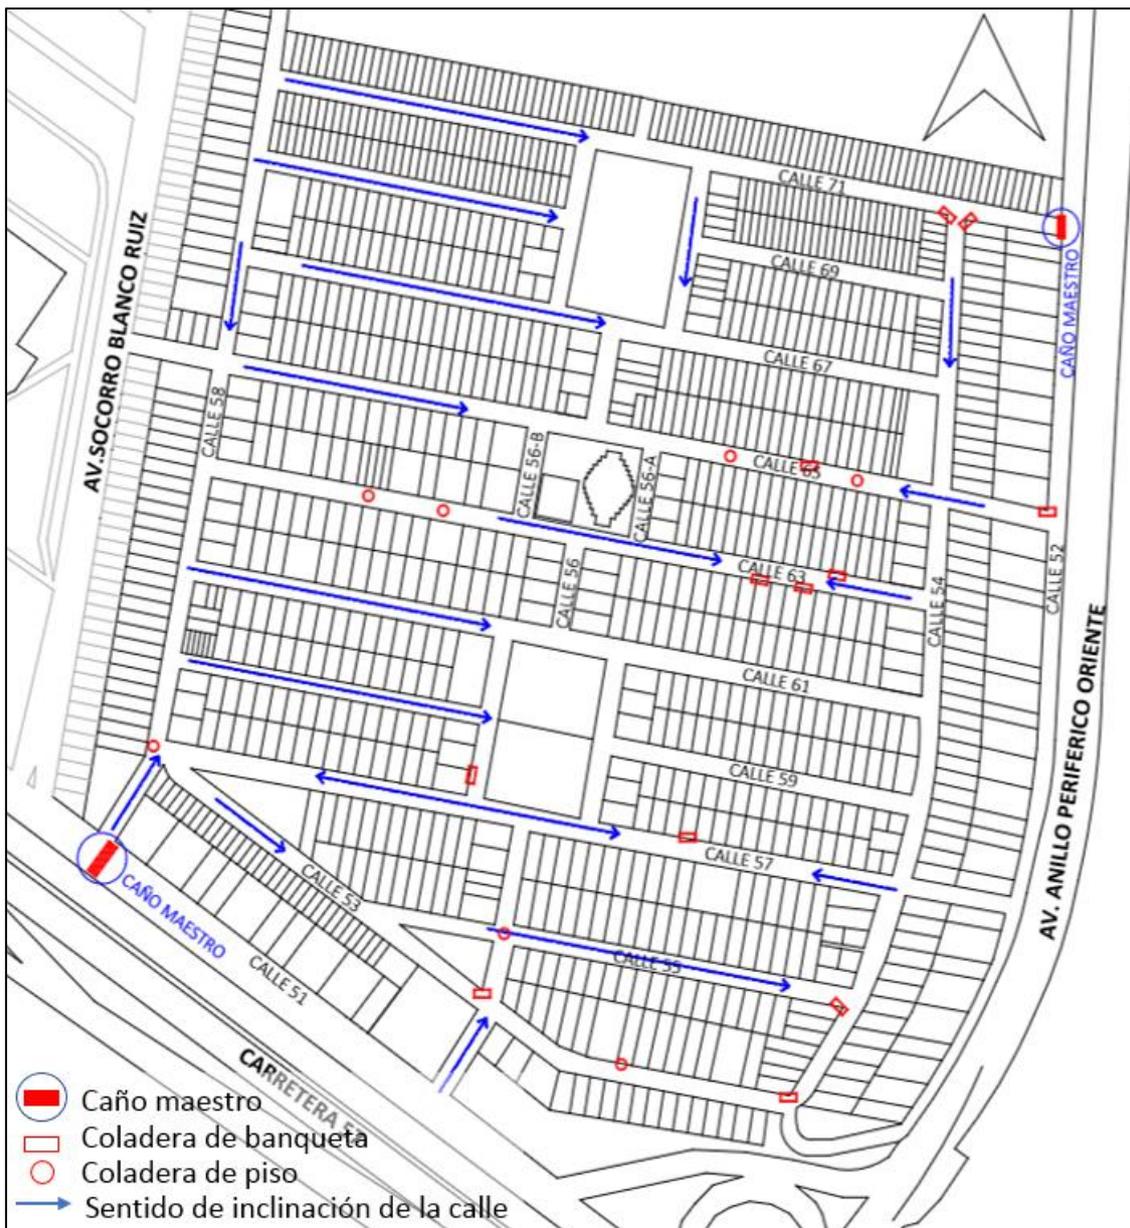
Alcantarilla actual del Fraccionamiento.
